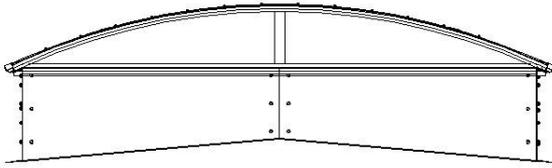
Typische Variante Lichtband-Zarge mit Wärmedämmung und Dachabdichtung
